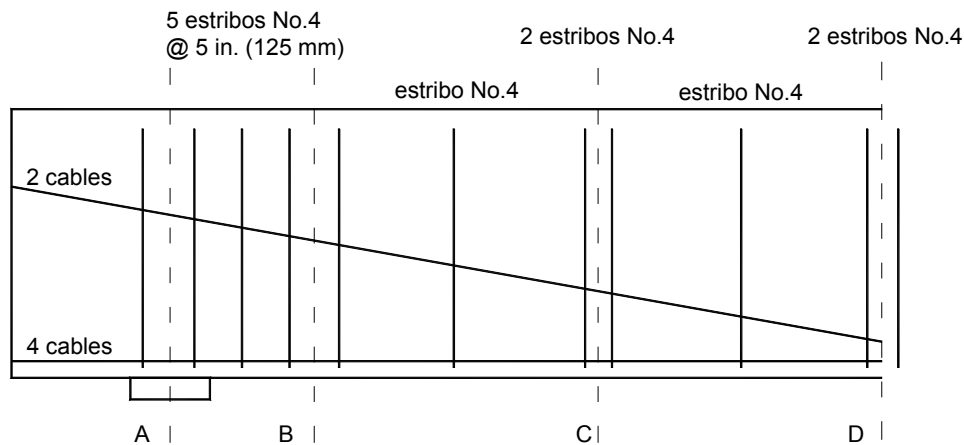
Configuración de las armaduras en el extremo de la viga
